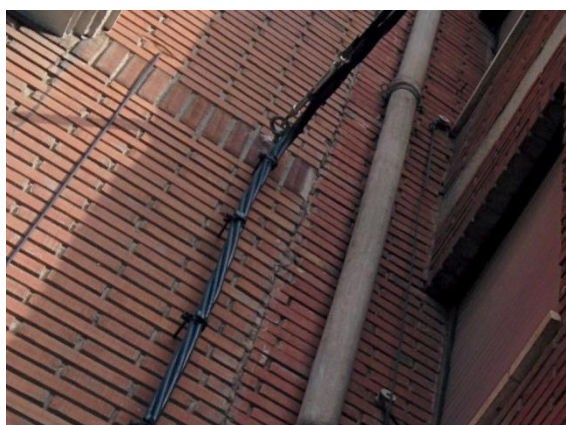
Grieta por falta de junta en fachada de 1969
